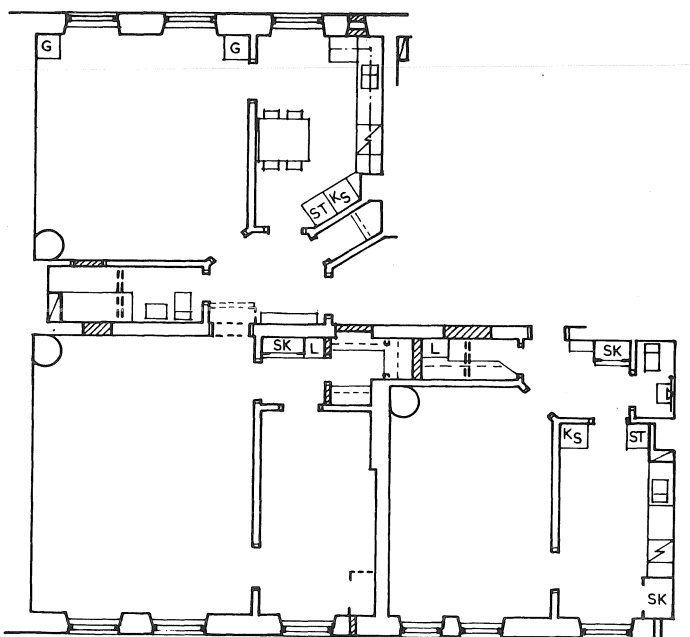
Enklare sammanslagning till 1 rok o. 3 rok
